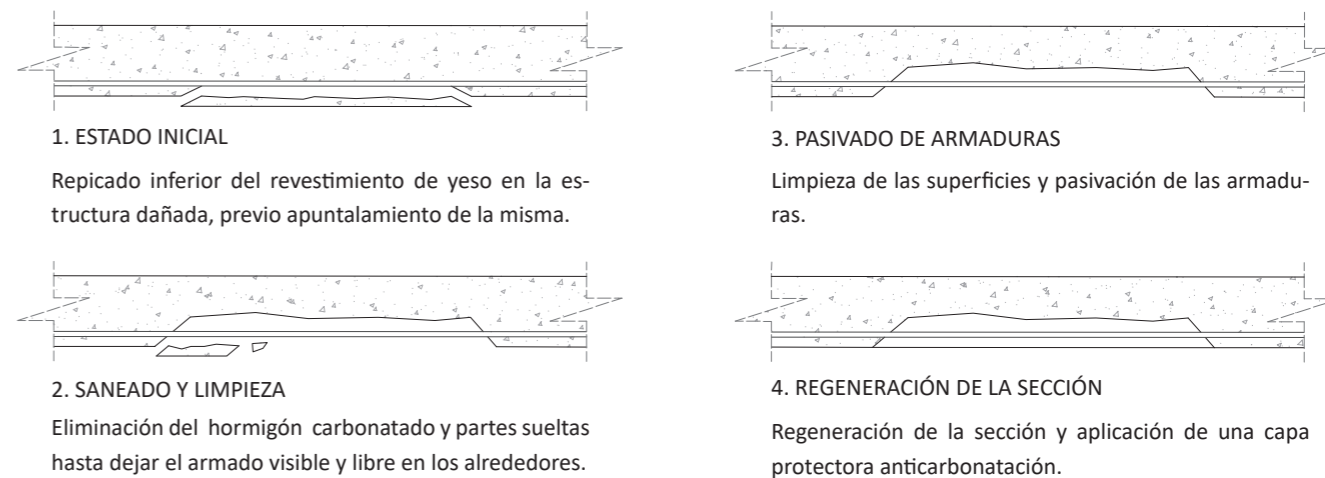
Detalle constructivo. Proceso de reparación estructural.
